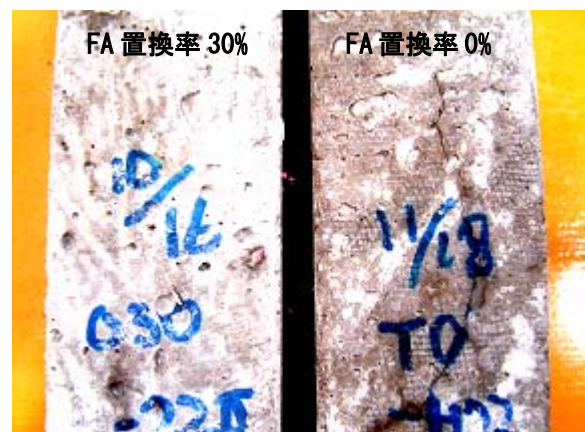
膨張量約6000μの試験体のひび割れ状況
